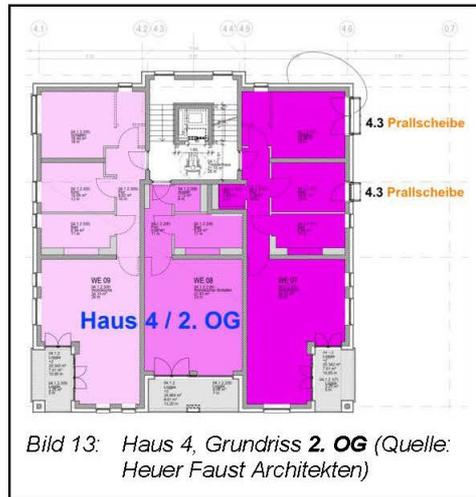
Haus 4, Grundriss 2. OG (Quelle: Heuer Faust Architekten)
